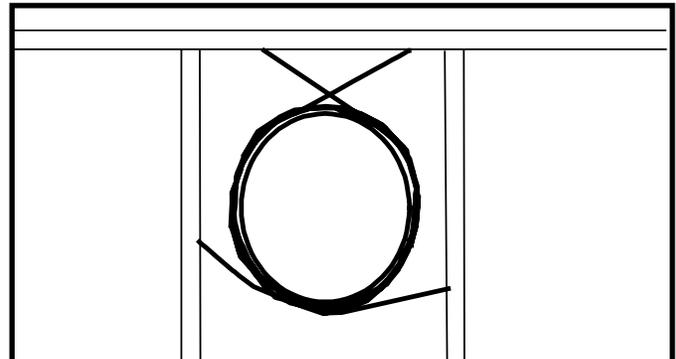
Sujeción de las secciones horizontales del tubo de escape
